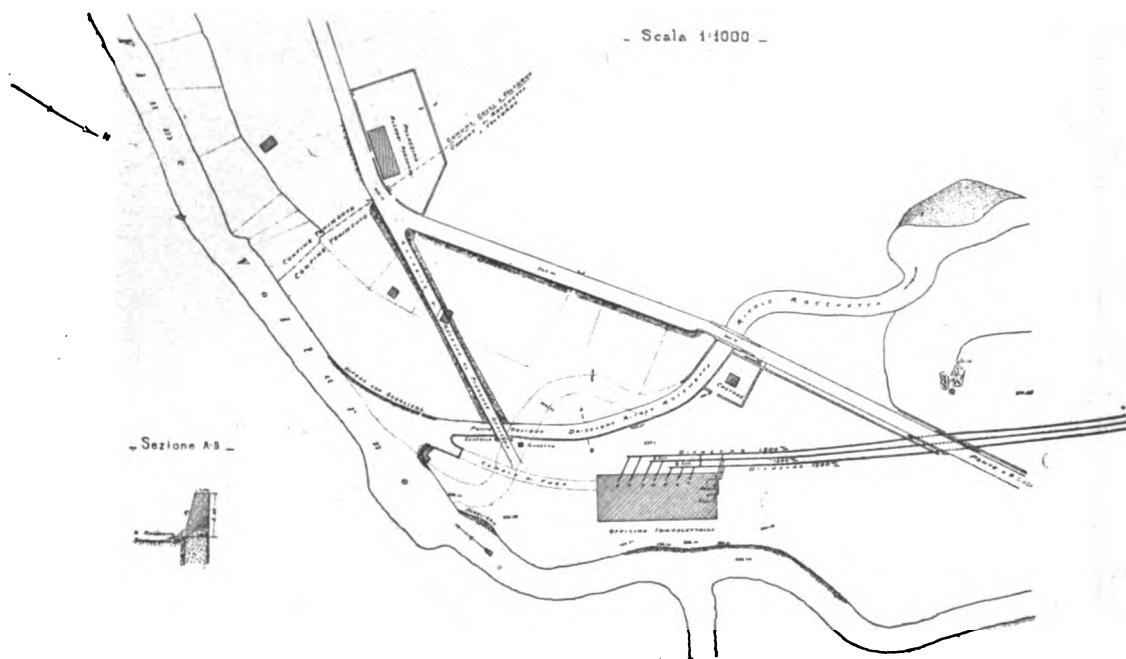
Planimetria del sito d'impianto della stazione generatrice idro-elettrica.
